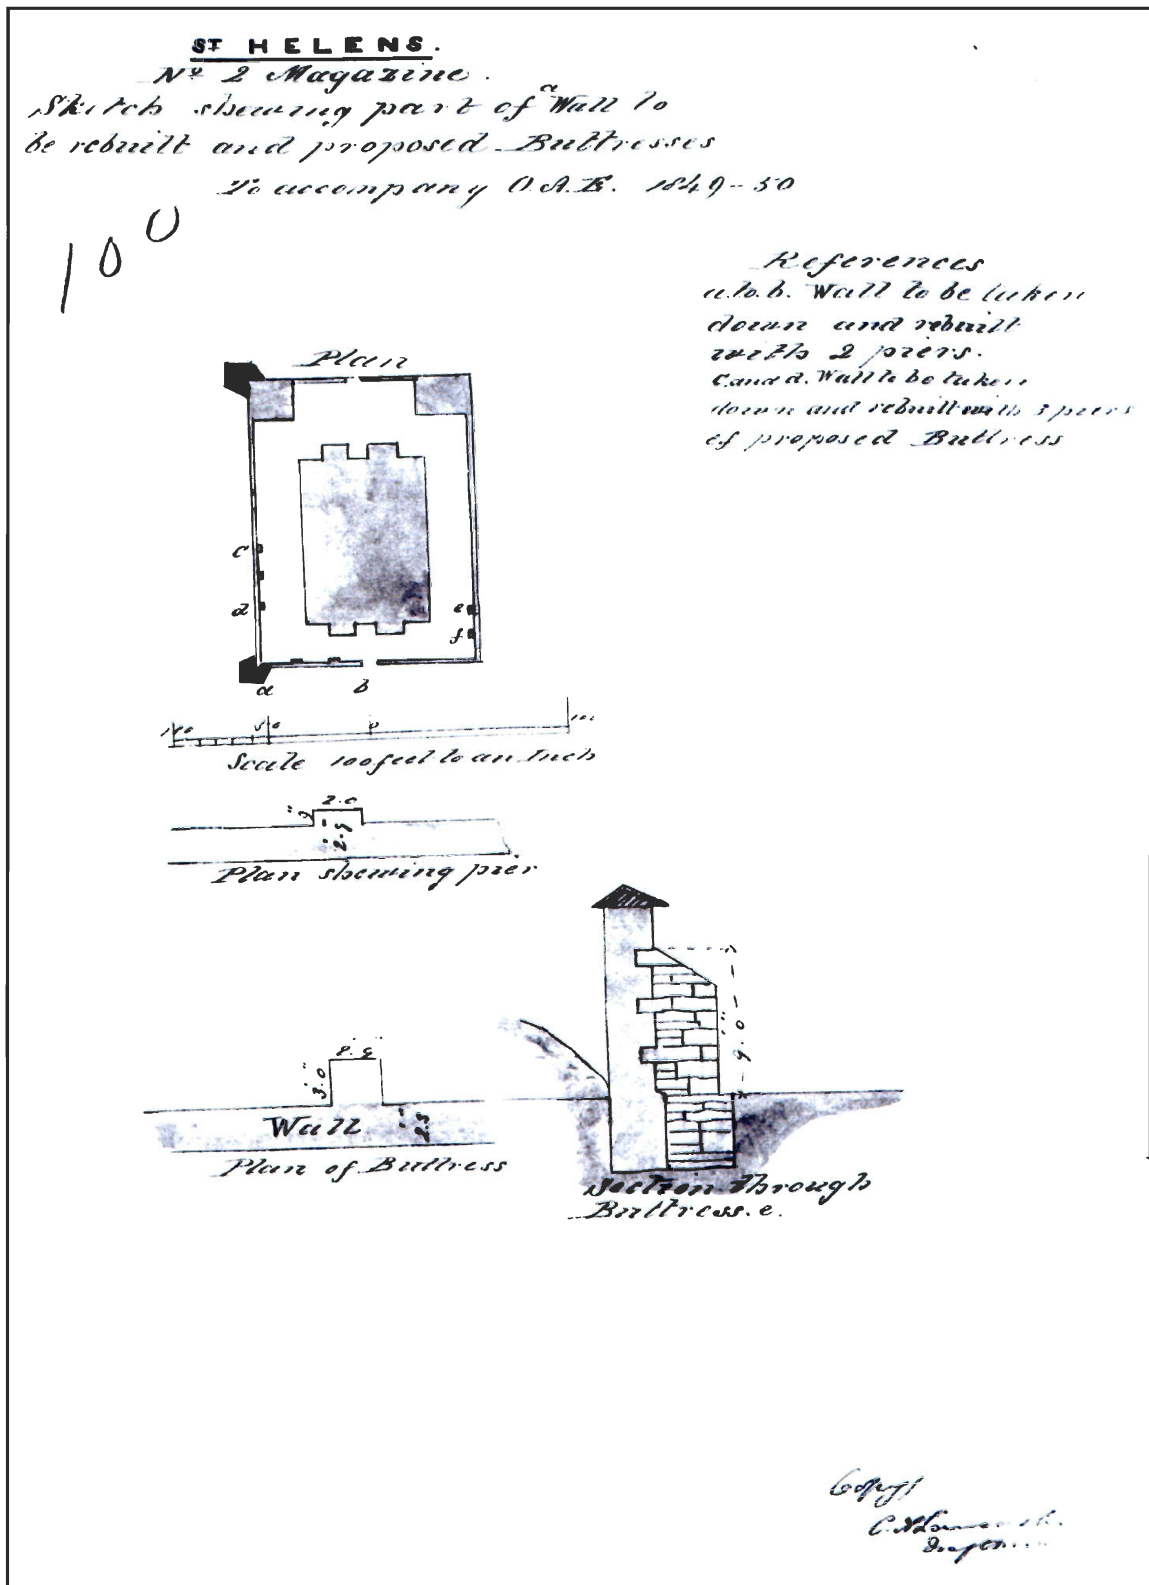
« Sketch shewing part of a Wall to be rebuilt and proposed Buttresses », 1849 (Musée Stewart)
